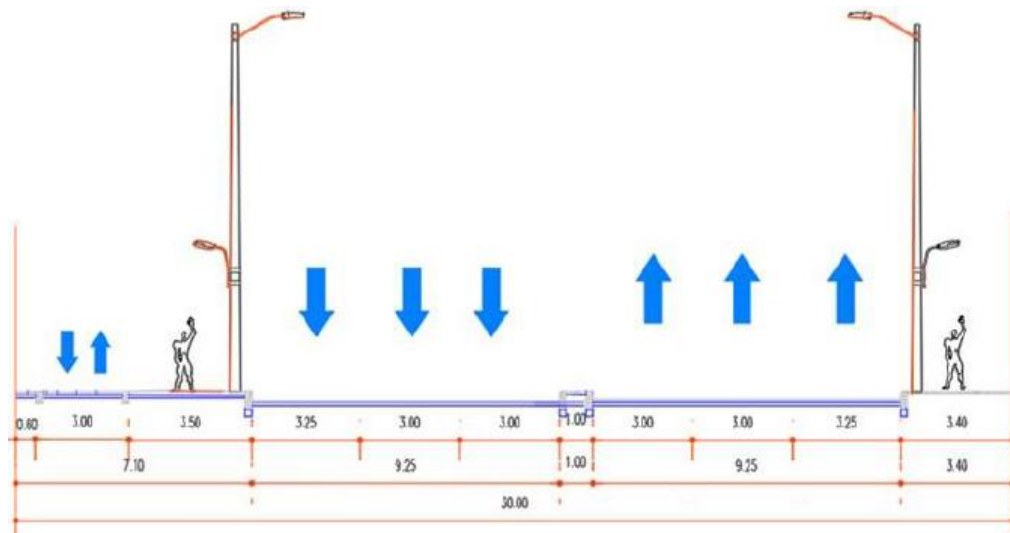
Sección vial propuesta entre la Carrera 114 y Carrera 122
